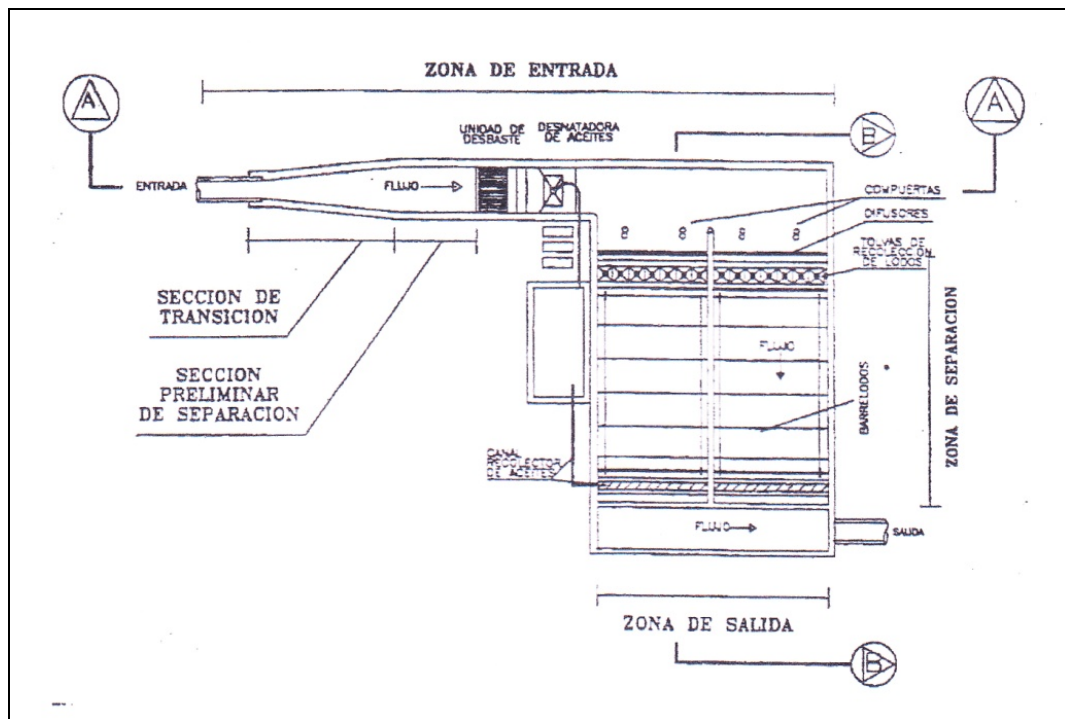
Planta de un separador API (PDVSA, 1999).
